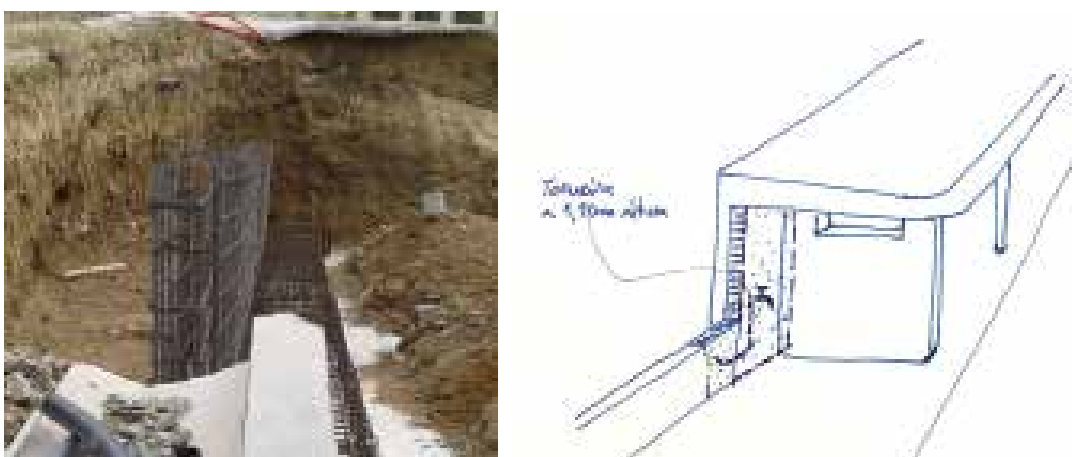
Correção do alinhamento do muro existente com a estrutura do Telheiro – situação de obra e esquisso de correção. (Ilustração nossa, 2017).
